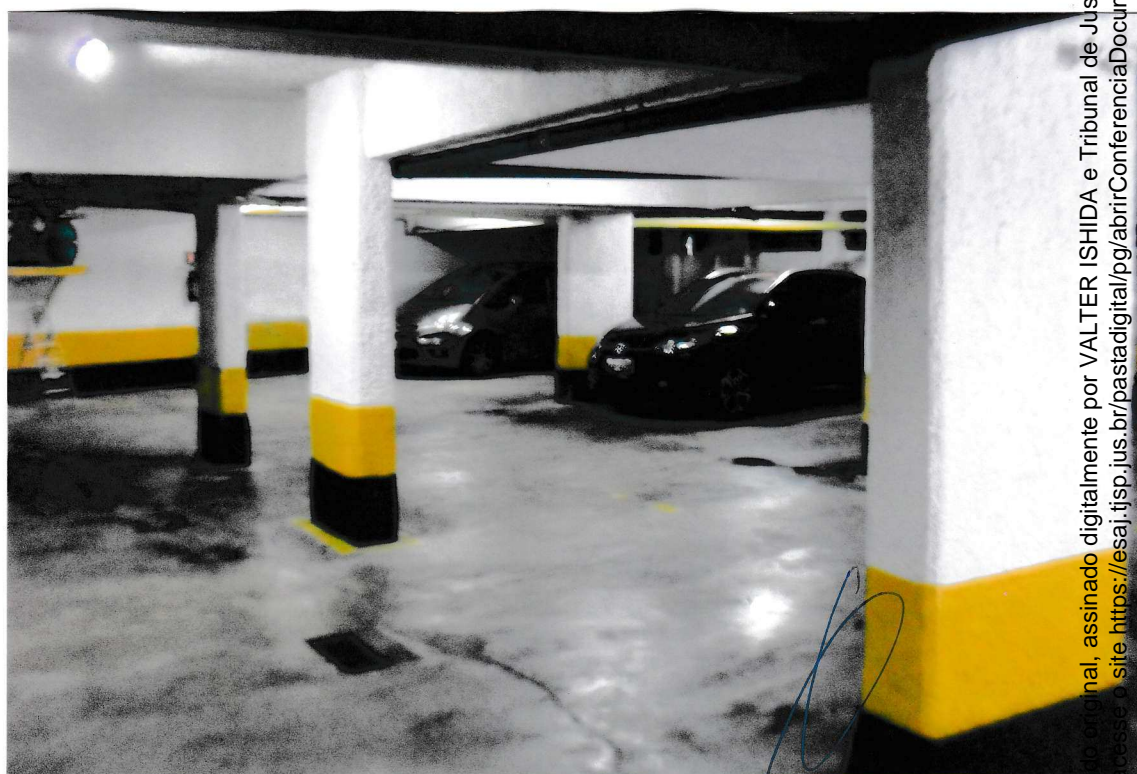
Detalhe da garagem coletiva no subsolo com vagas indeterminadas
